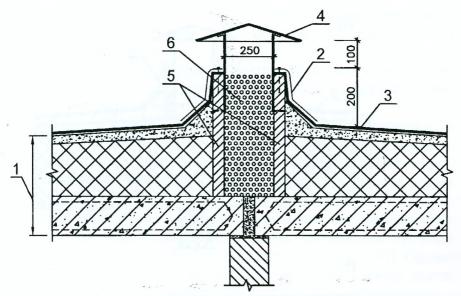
Устройство осущающего канала в коньке крыши: 1-осущаемое совмещенное покрытие; 2-металлический фартук; 3-кровельный ковер; 4-металлический зонт; 5-кирпичные стенки канала; 6-засыпка из керамзитового гравия
